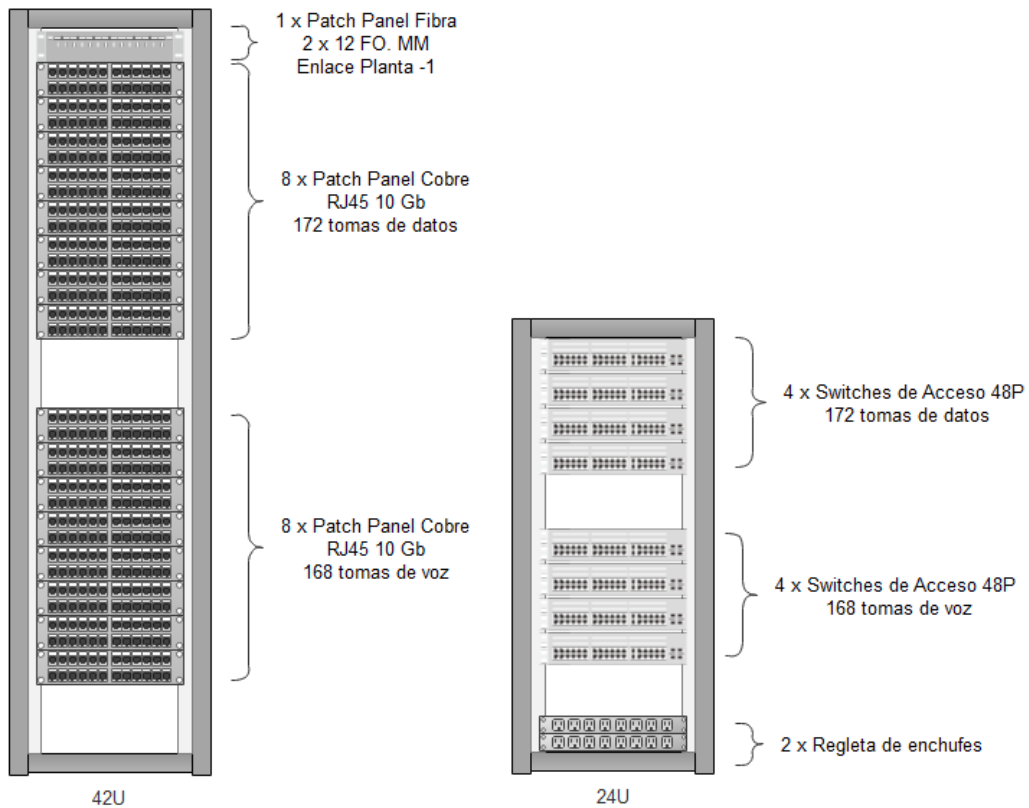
Sede 1 - Diseño Repartidor Secundario1 Planta Baja
